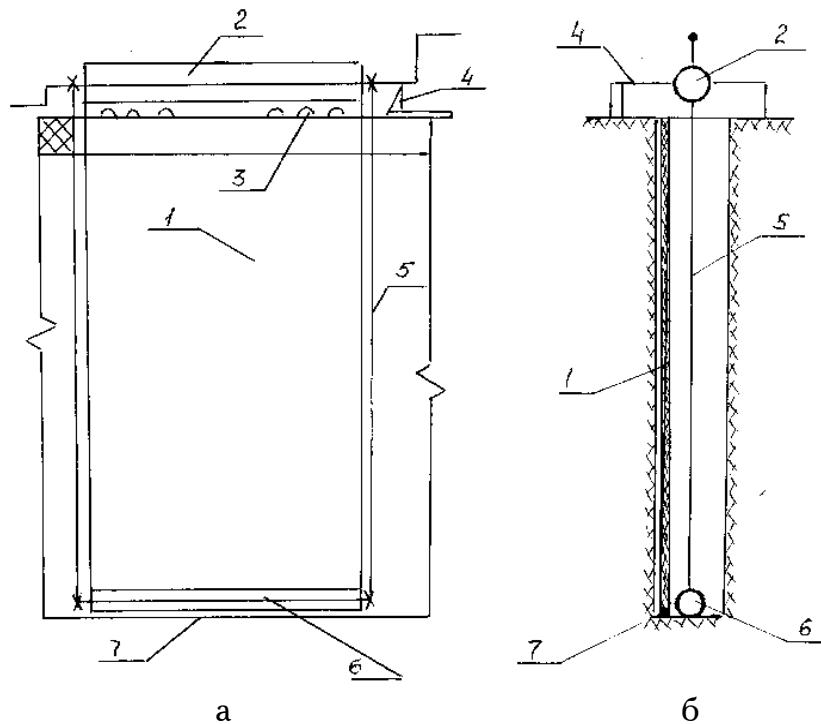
Установка для укладки пленки на стенке траншеи:
